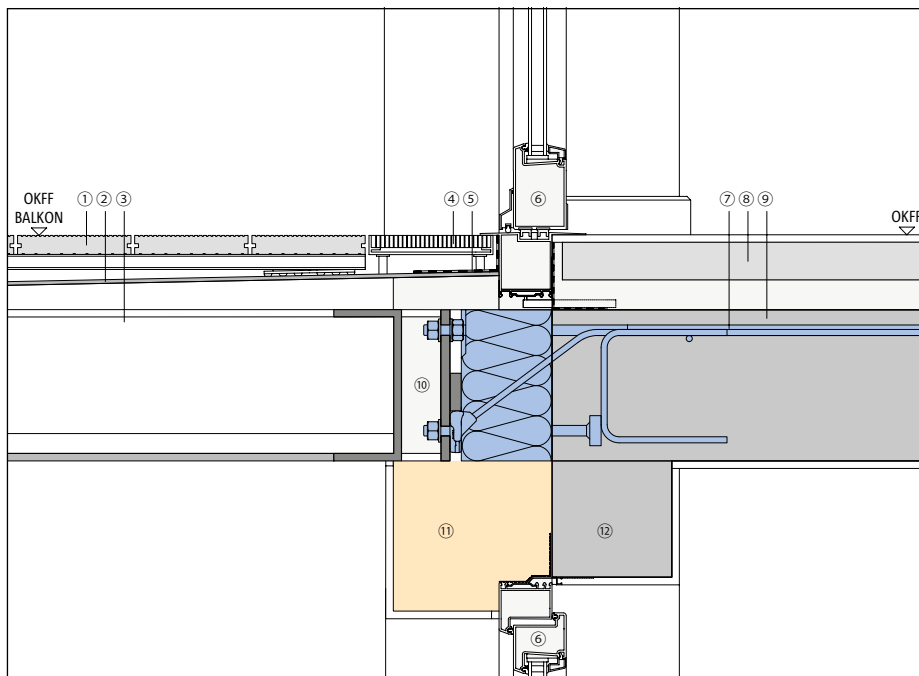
| M. 1:10 Fertigteilbalkon ohne Aufbau
